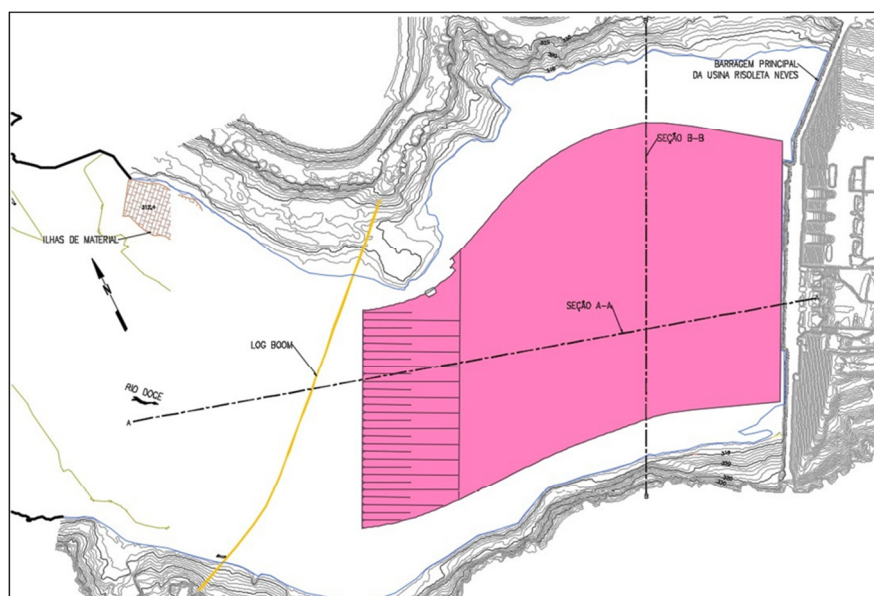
Planta de dragagem EL.302 – Fase 2 - 2a Etapa
